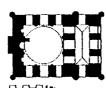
مسقط أفقى لتربة بايزيد يلدريم فى بورصة (أو بروسة) . (عن : Wilde) .
